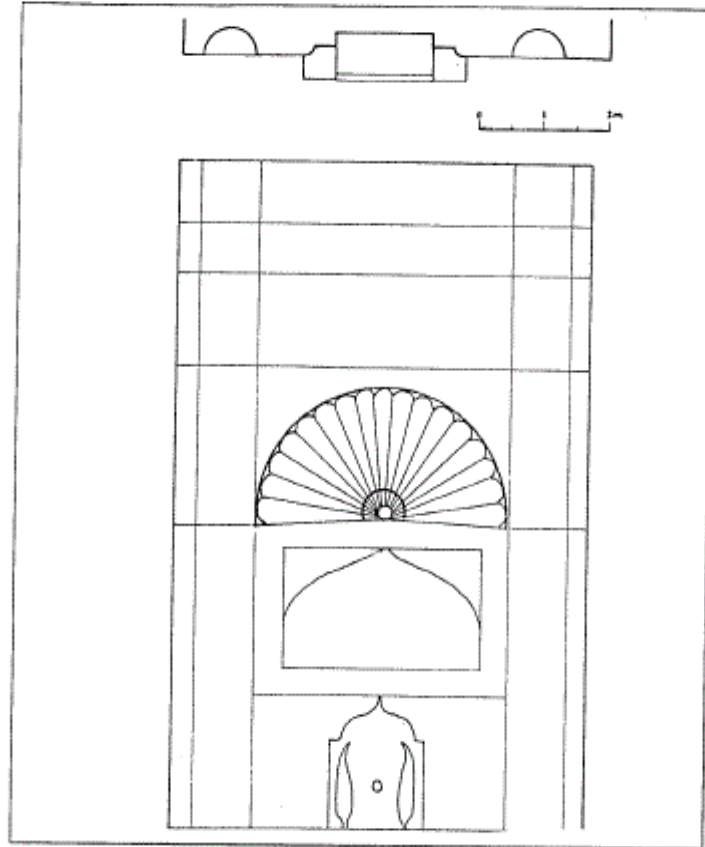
مسقط أفقي لخشمة حسين باشا في أدرنة (عن: ÖNGE).
